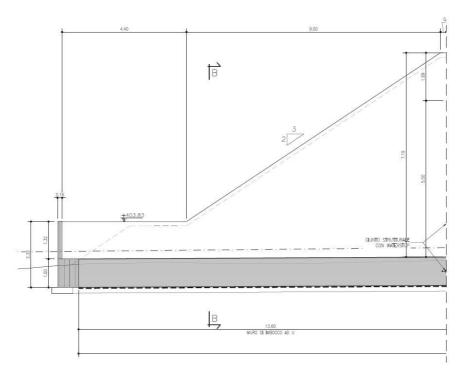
Muri di sbocco - Sezione longitudinale
